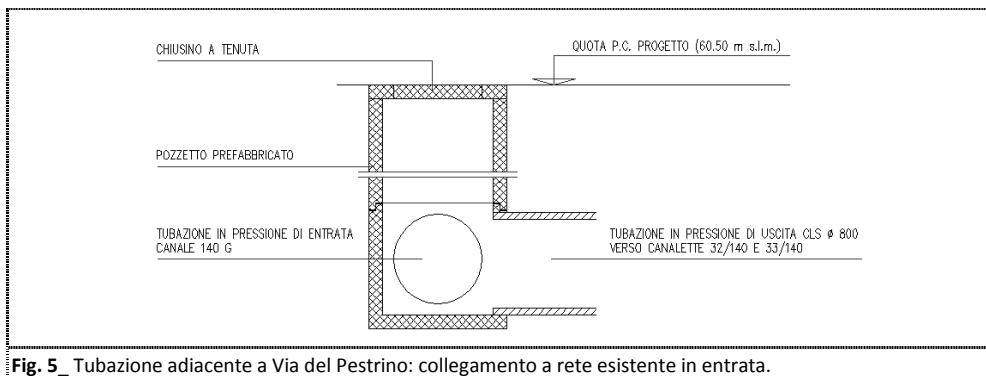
Tubazione adiacente a Via del Pestrino: collegamento a rete esistente in entrata.
